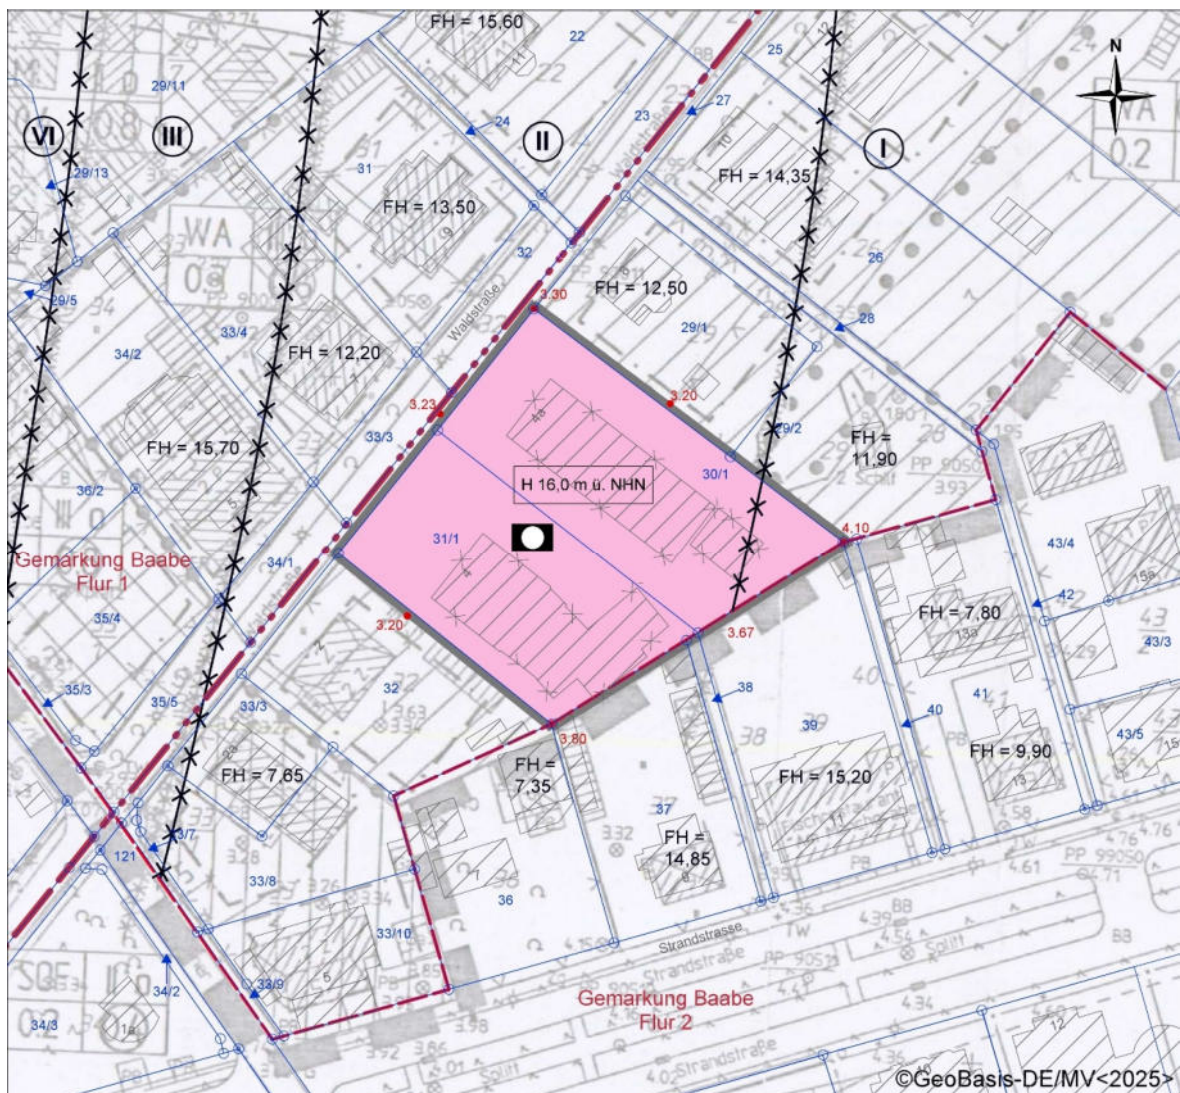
Überlagerung Ursprungsbebauungsplan mit 3. Änderung
